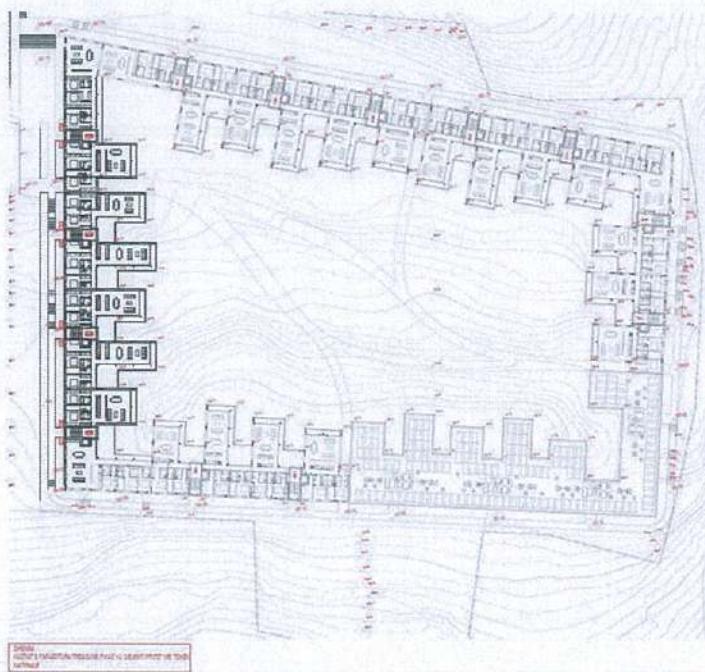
Planimetria e tarraces ne Kuoten + 208.45
